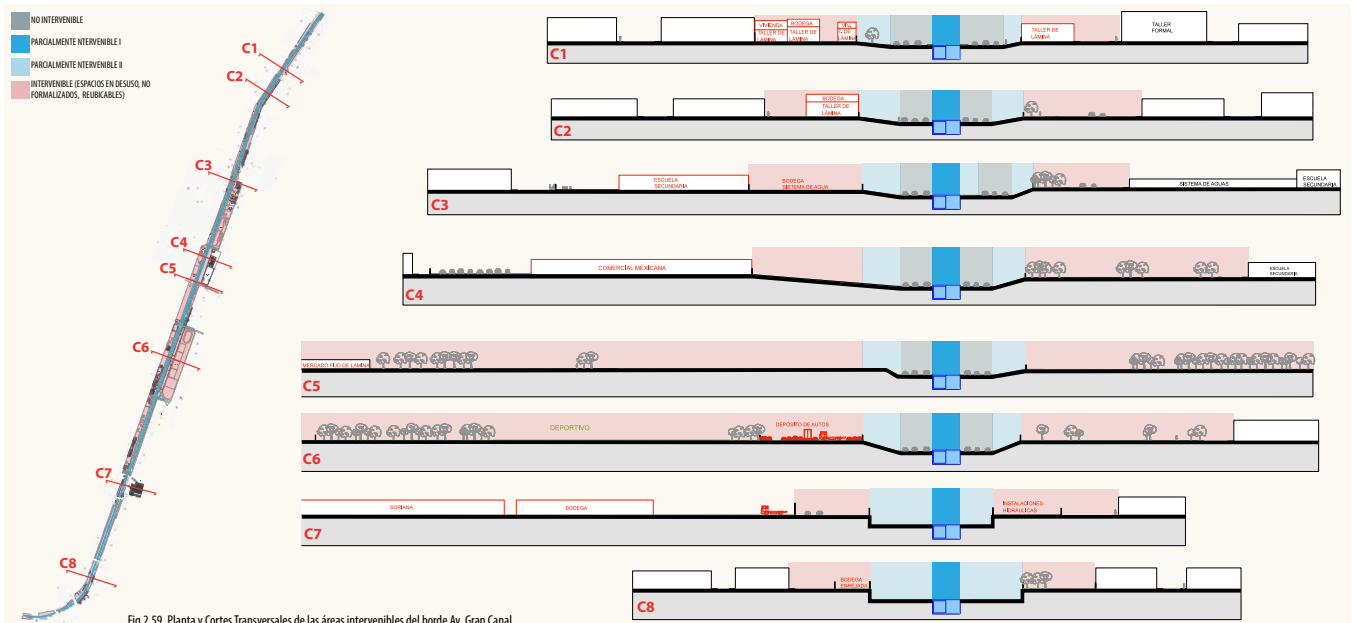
Planta y Cortes Transversales de las áreas intervenibles del borde Av. Gran Canal.
